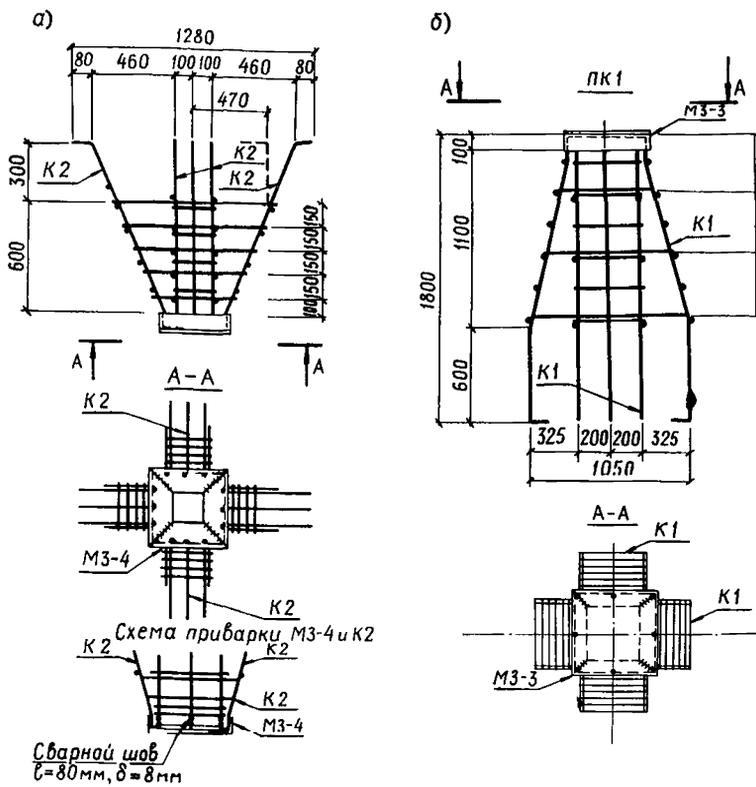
Схемы армирования верхнего (а) и нижнего (б) контрфорсов в 5-этажном крупнопанельном здании серии 122 с ВС
